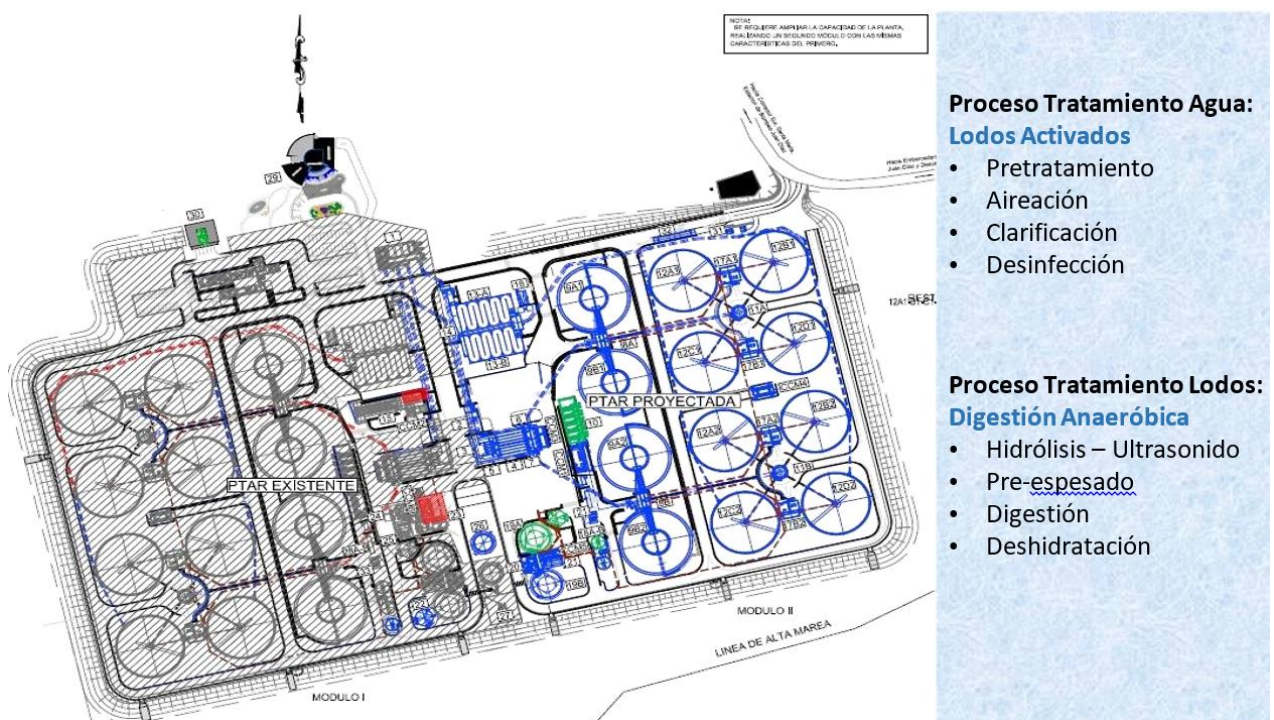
PLANTA DE TRATAMIENTO DE LA BAHIA DE PANAMA Fuente: (Página oficial saneamiento de Panamá)
